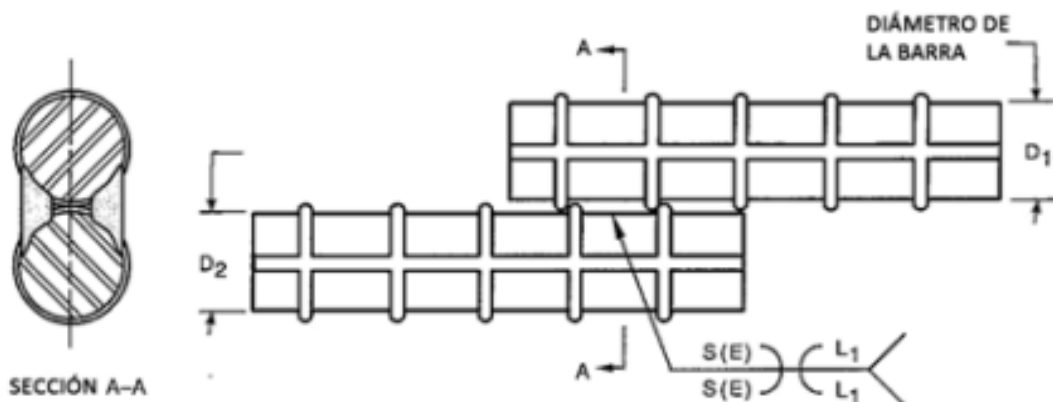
Detalle geométrico para soldadura en posición 3G [2].
